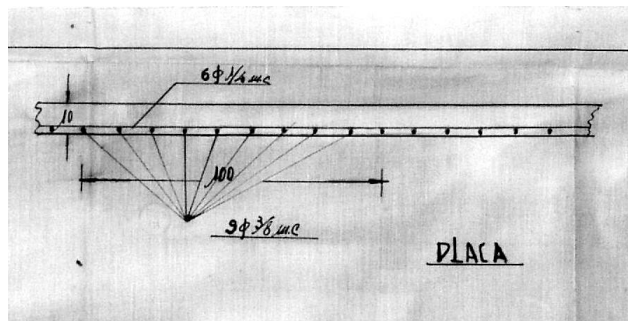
Pormenor construtivo da armadura das lajes do pavimento no piso 1 [6]
